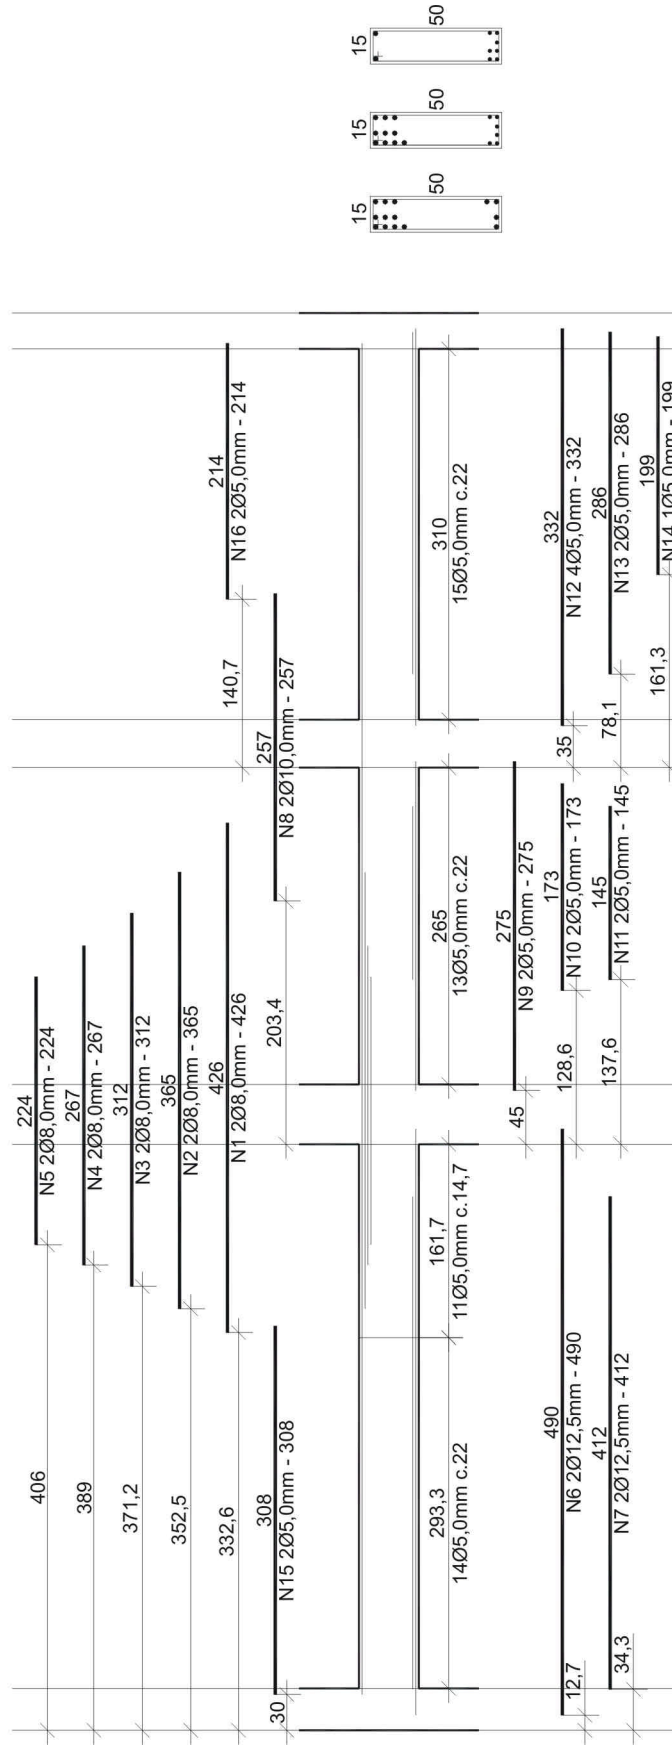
Detalhamento Viga 04.7, realizado pelo VigaCalc.
